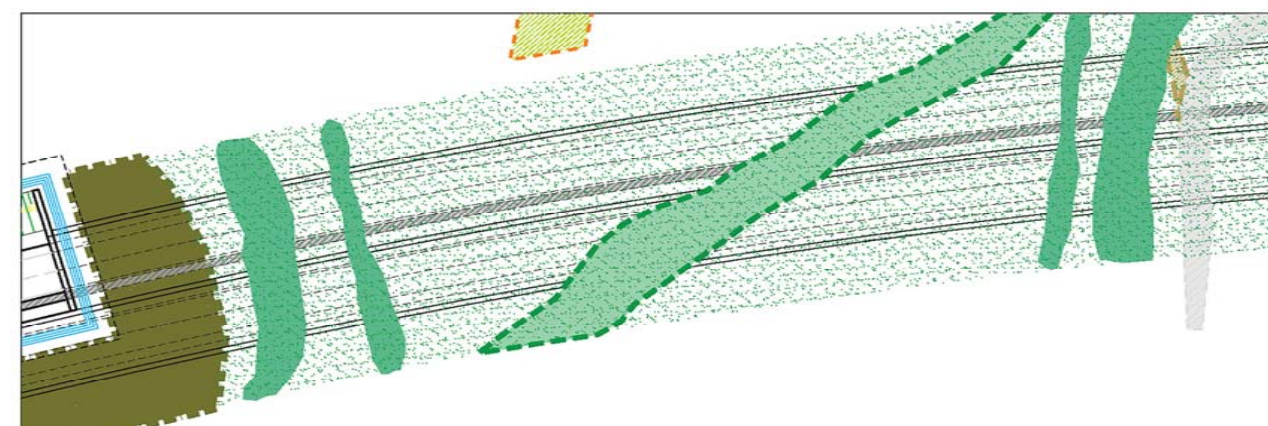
Passaggio faunistico con vegetazione di invito sopra le gallerie artificiali - Planimetria
